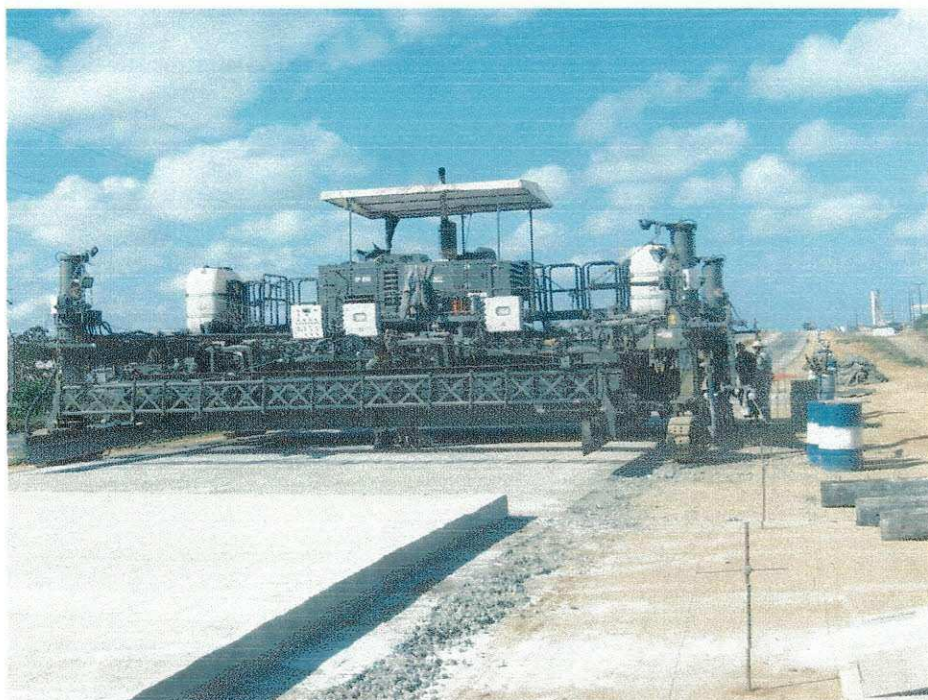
Execução do pavimento rígido (visita BR 101, 2008).
